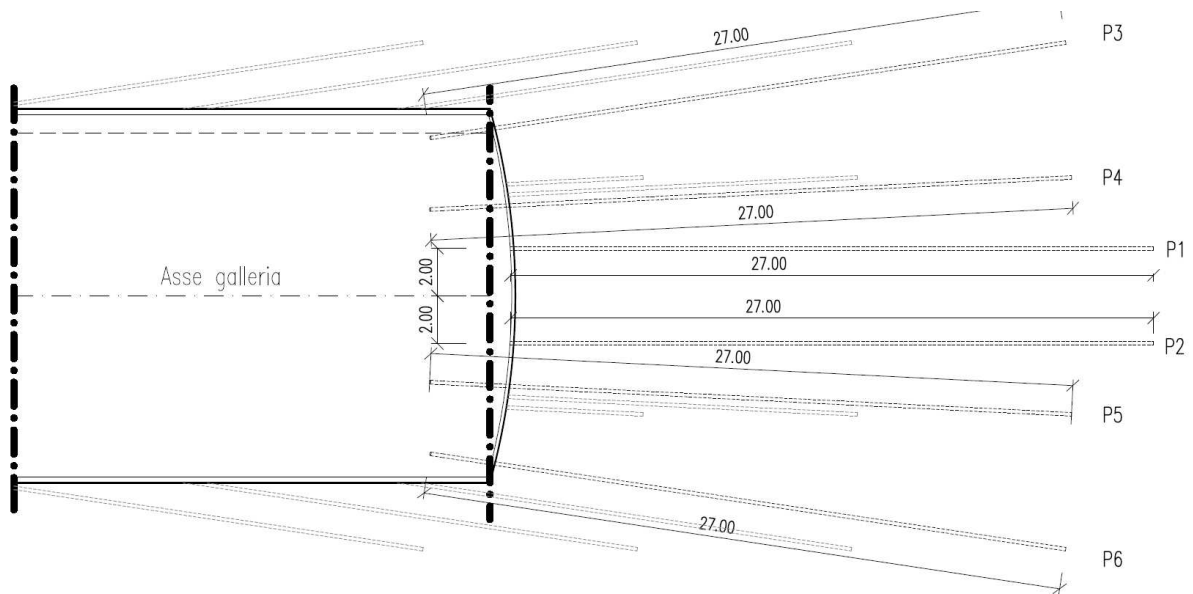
Perforazioni in avanzamento. Schema posizionamento fori – planimetria
